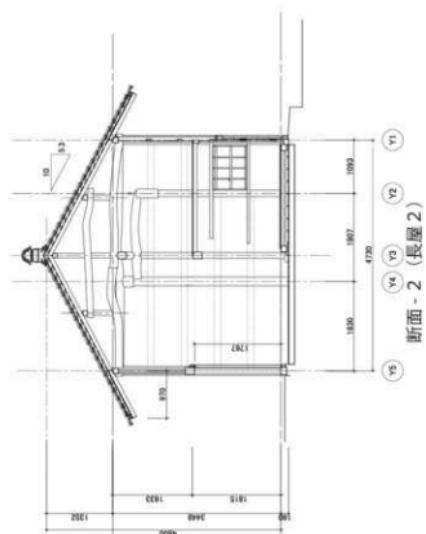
長屋門 基本 断面図 1 S=1/100
